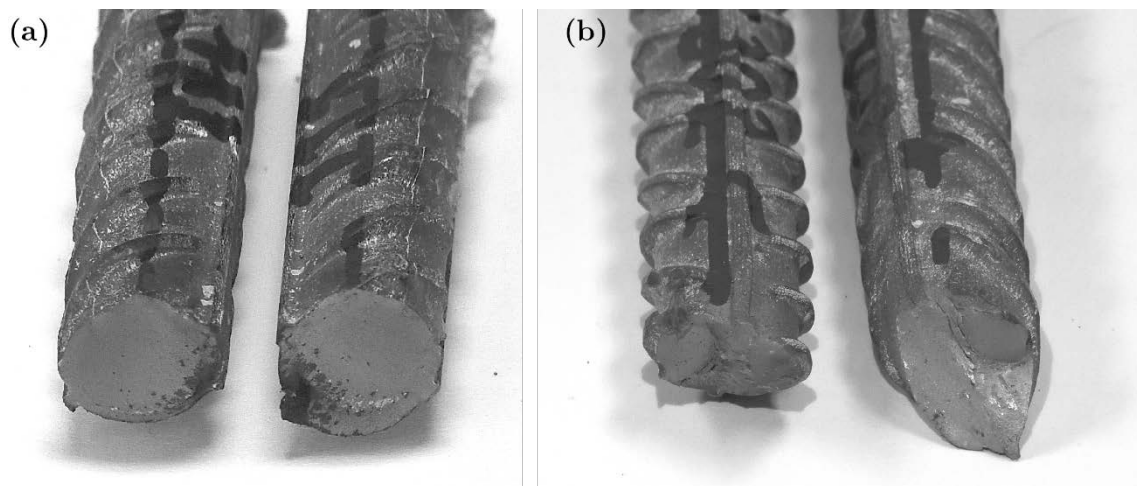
Ermüdungsbruchflächen im Bewehrungsstahl: (a) Versuch A1 und (b) Versuch B1.
